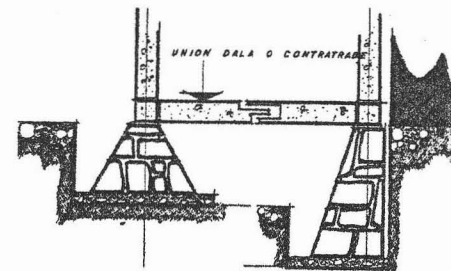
Cimentación para terreno con pendiente o cargas desiguales
